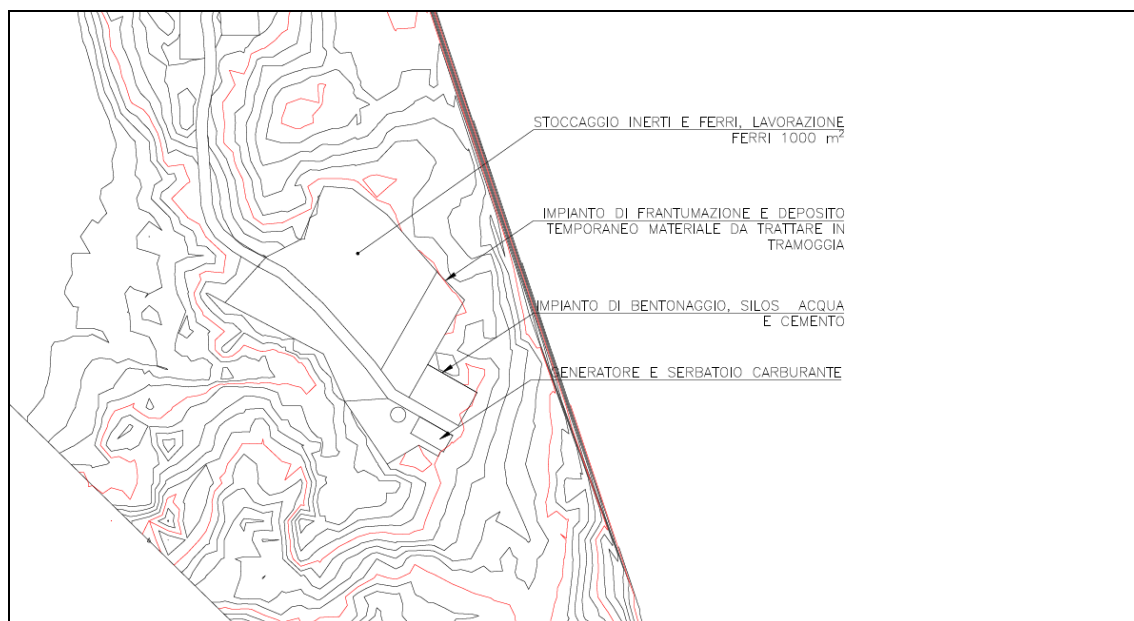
Dislocazione cantiere sud (Fonte: Tavole progettuali)
